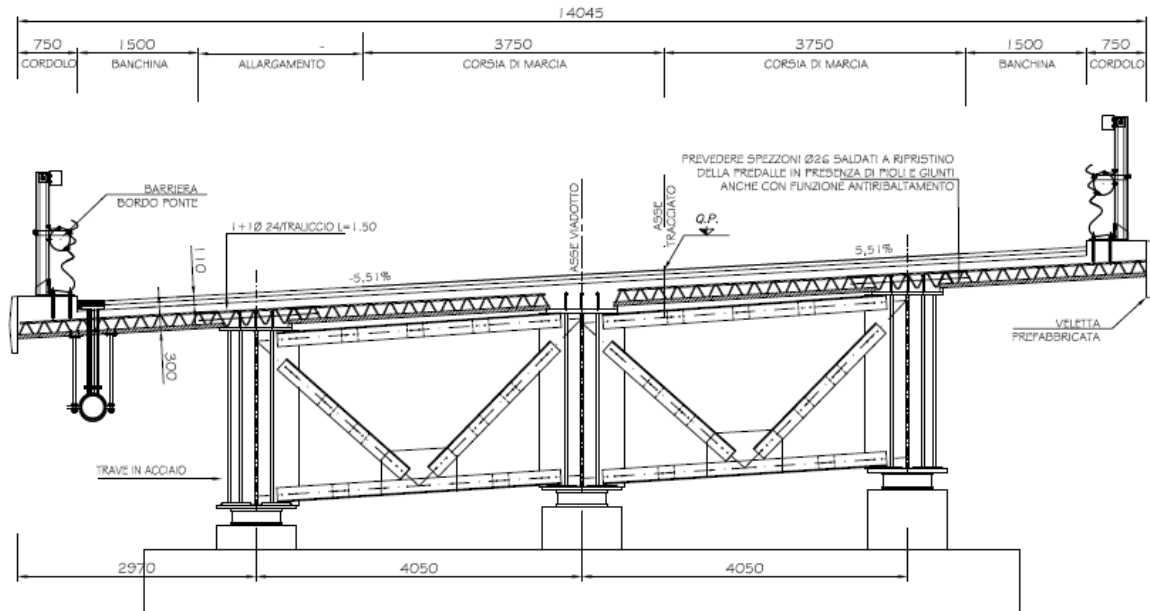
Viadotto dell'Acqua Calda: sezione in asse della pila 3
